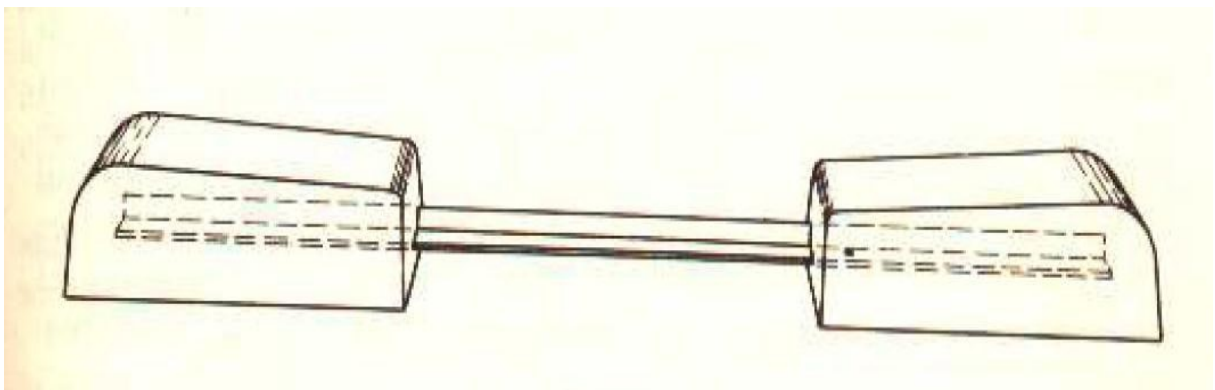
Travessa Misto (Fonte: Brina, 1988, 37)
